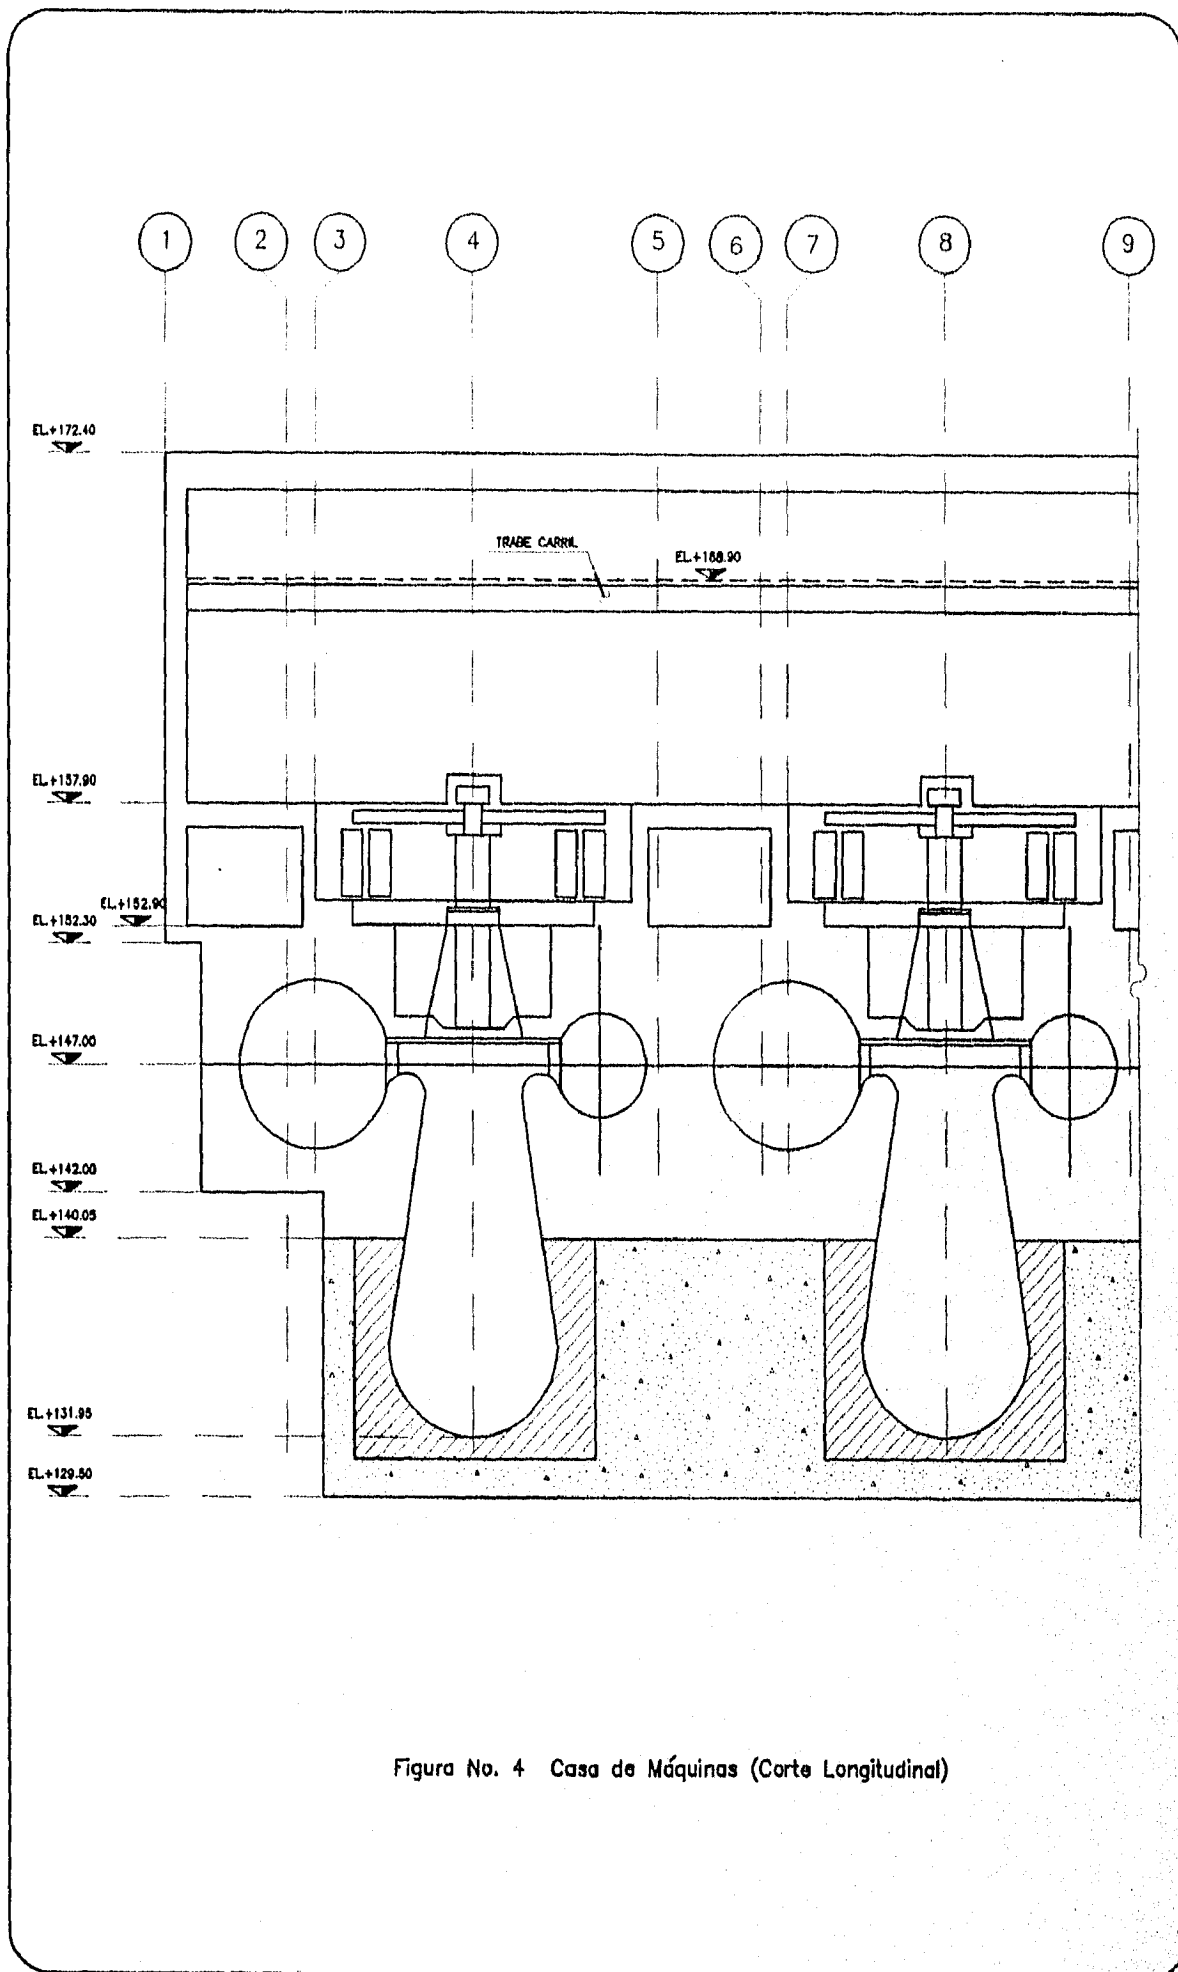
Casa de Máquinas (Corte Longitudinal)
